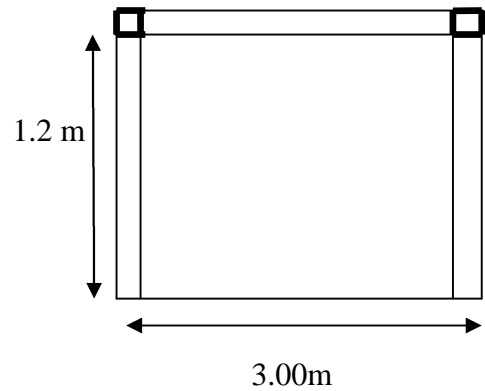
Vue en plan d'une dalle pleine sur 3 appuis
